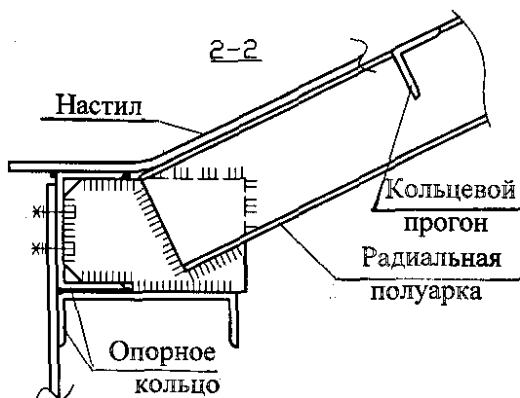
Узел сопряжения щита покрытия со стенкой резервуара (узел Б)
